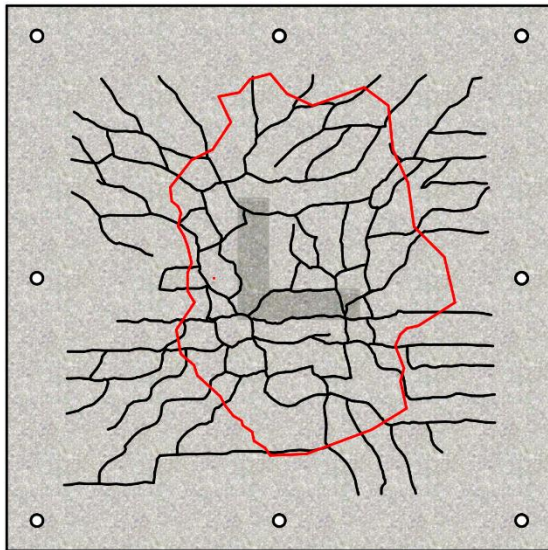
Padrão de fissuração da laje LR
